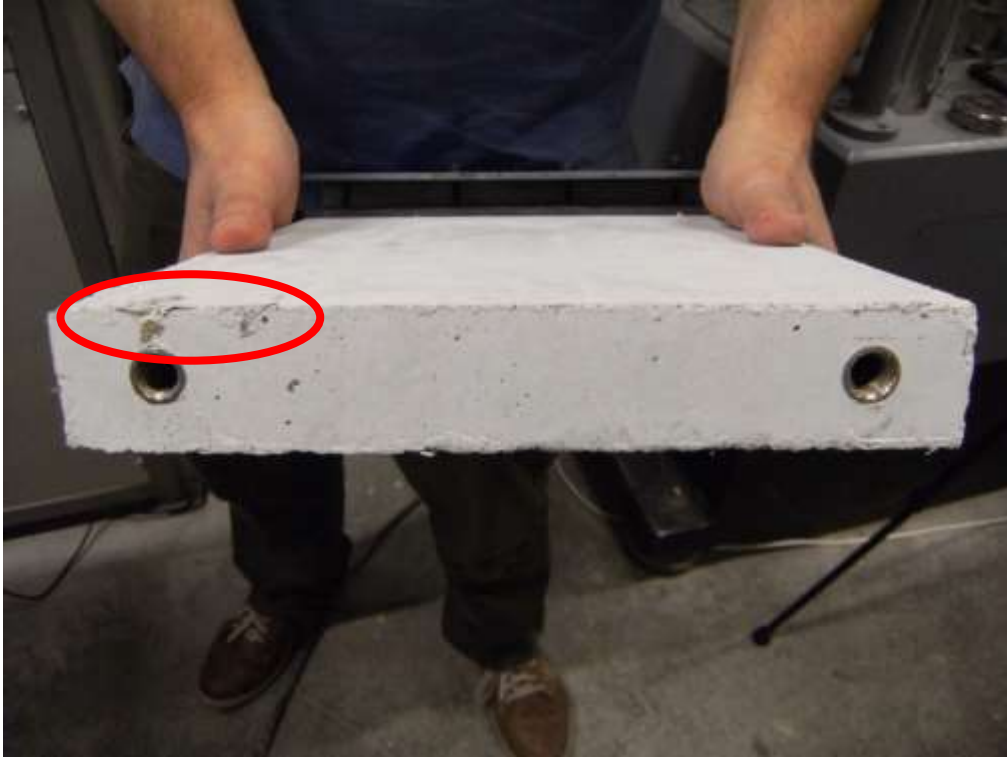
Fissura laminar (vista 4)
